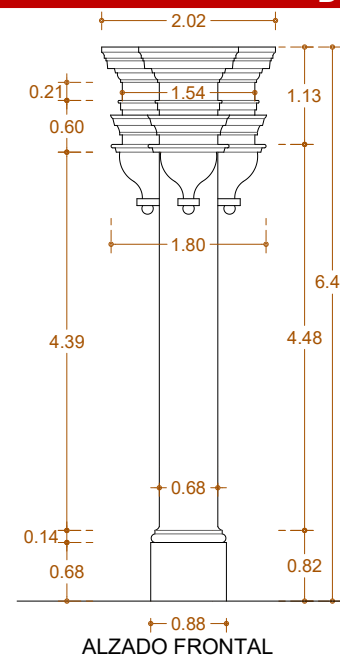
Pilastra Norte de Nave Tramo 1 Vista Frontal
